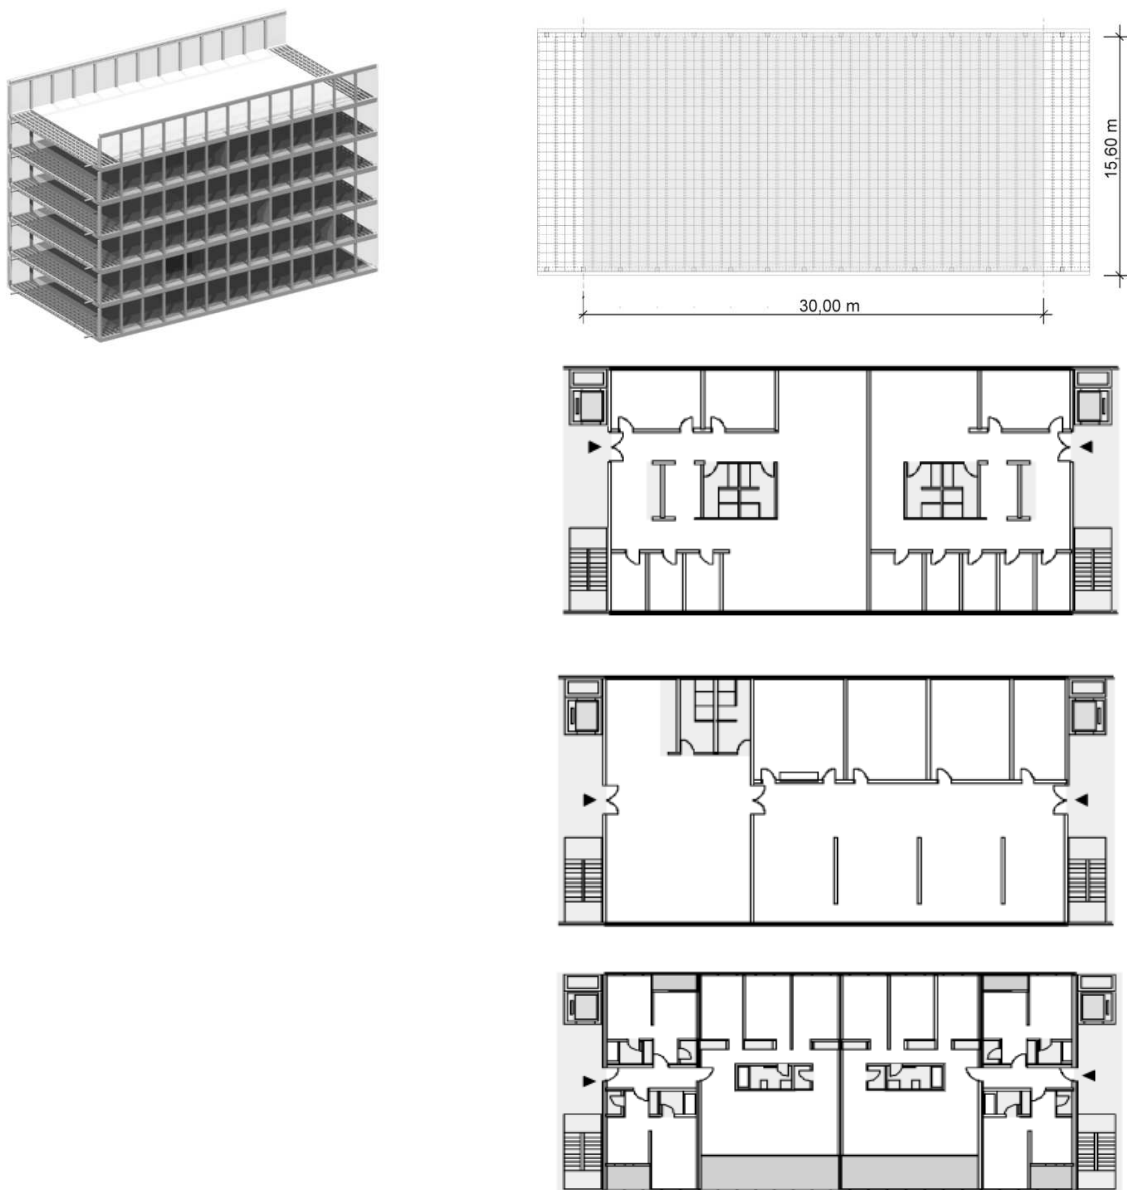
Beispielgebäude mit den Grundrissen Zellenbüro, Team-Center und Apartments
